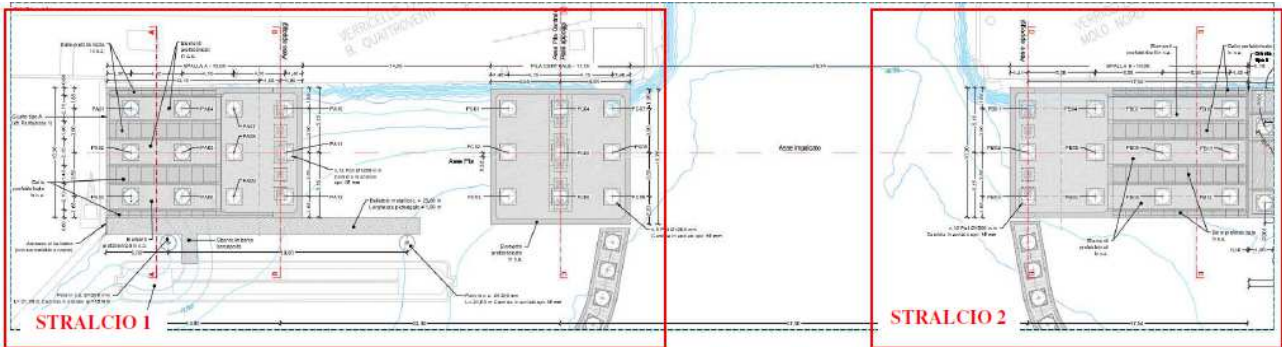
Planimetria generale Spalla A - Pila Centrale - Spalla B.
